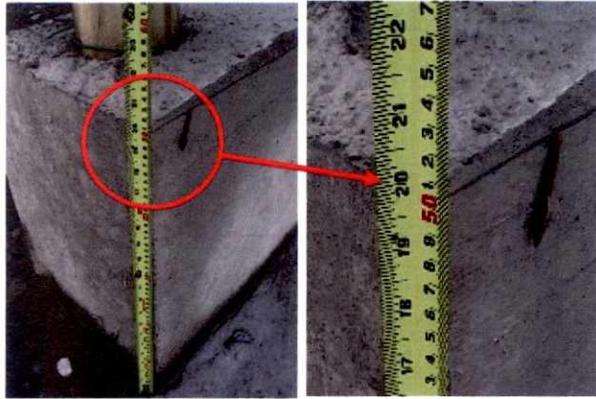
Viga dentada entre sitios D-02/D-03 e imagen "Detalle A" de la lámina N° 5 "Cierres de Protección", del proyecto modificado.
